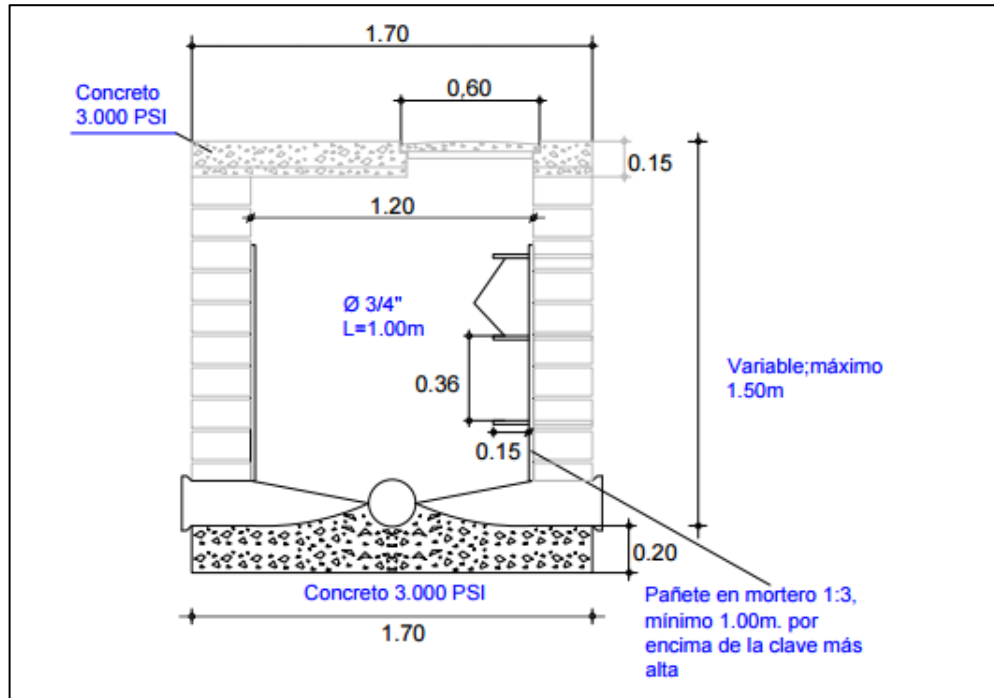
Detalle de pozo de inspección de altura menor a 1.5 m. (Fuente: Diseño alcantarillado EROCOM)
